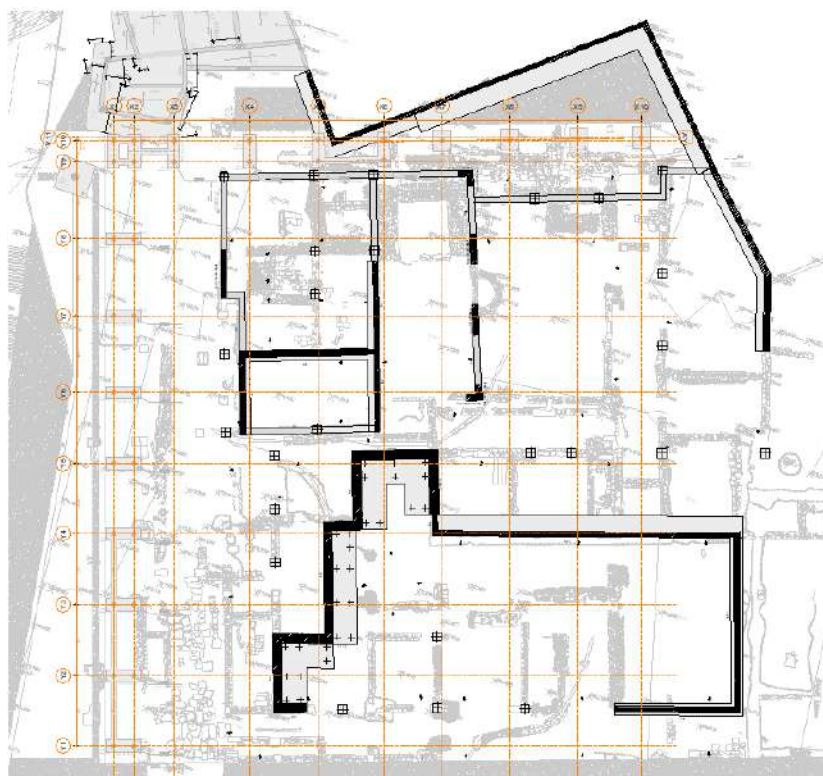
S3A - Planta de fundações Sítio Arqueológico
